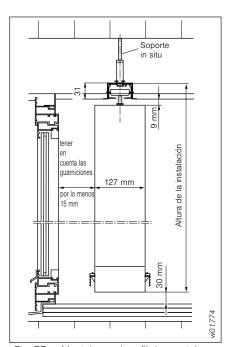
Montaje en el perfil de montaje con ranura de montaje
